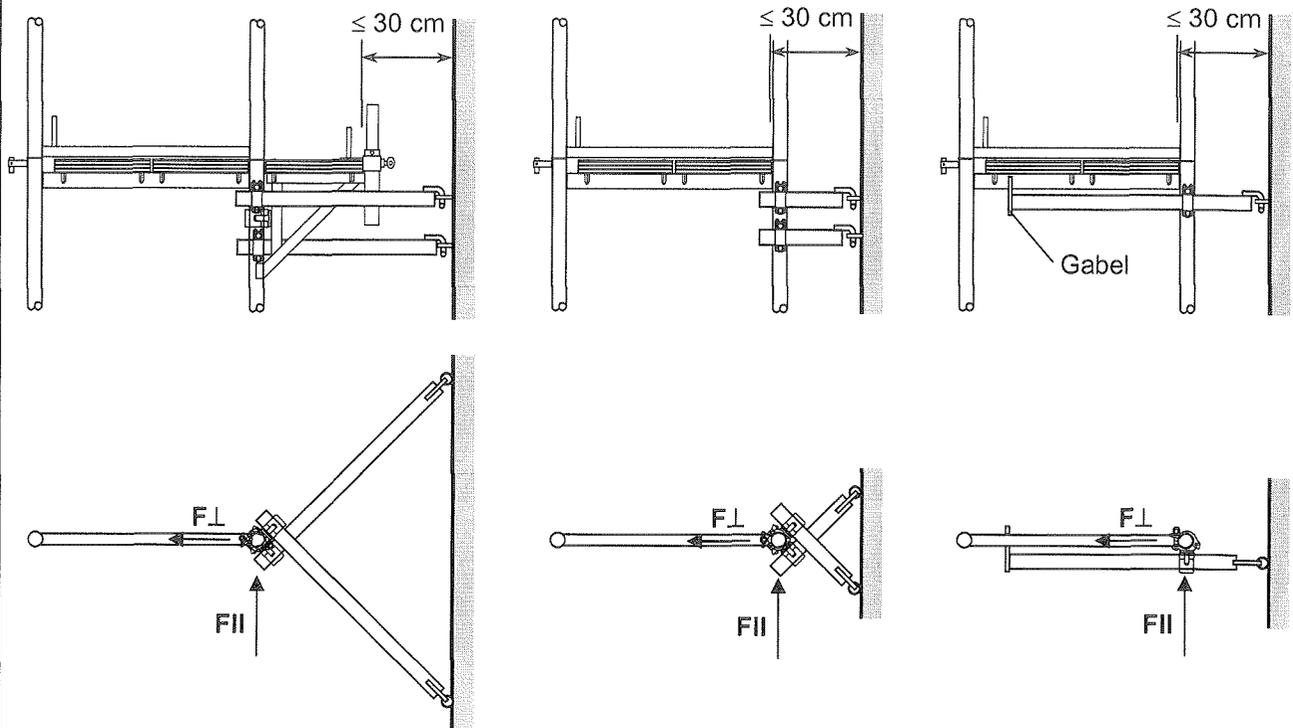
Höhenlage der Gerüsthalter bei Anschluss im „Knoten“.
